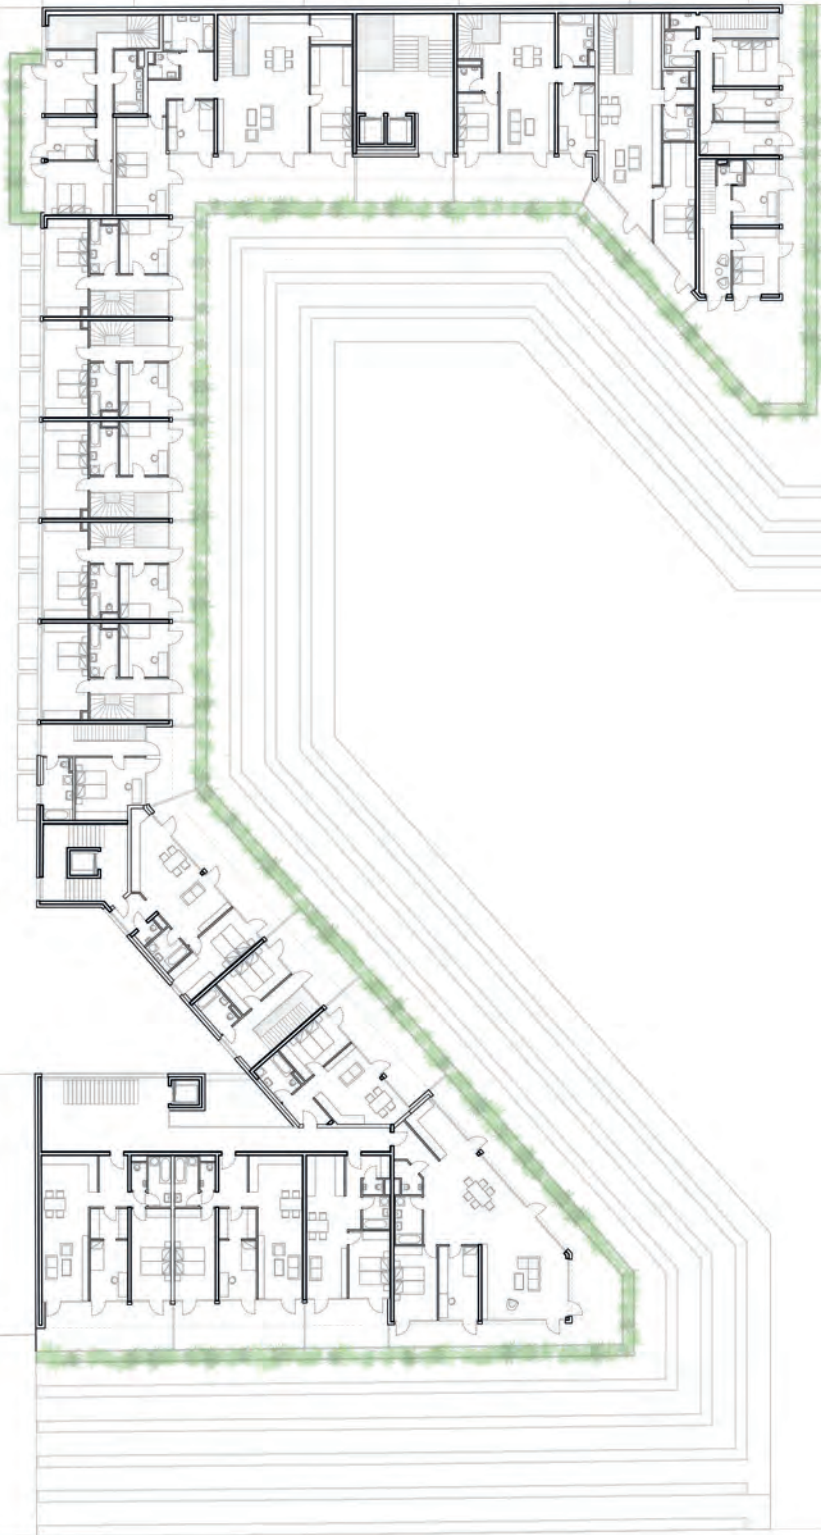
links: Grundriss 3. Obergeschoß.
